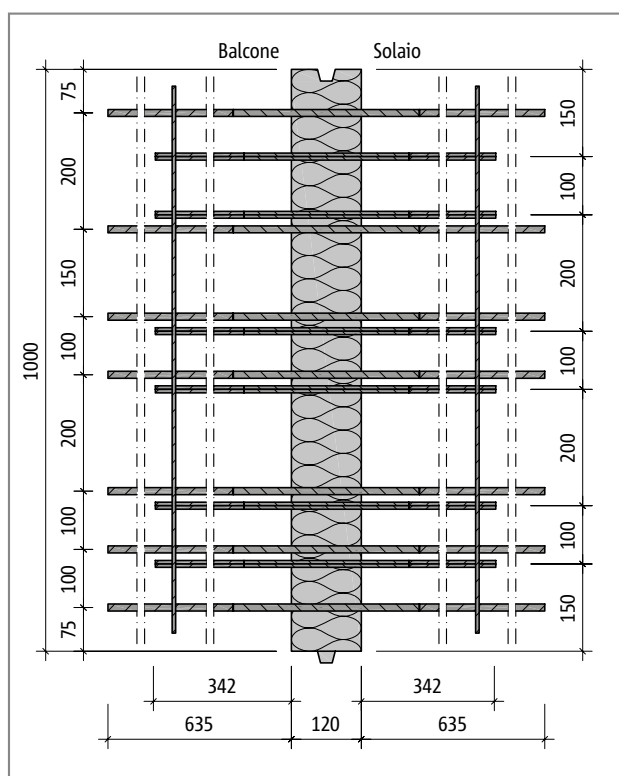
Schöck Isokorb® tipo DXT50-VV6: pianta
